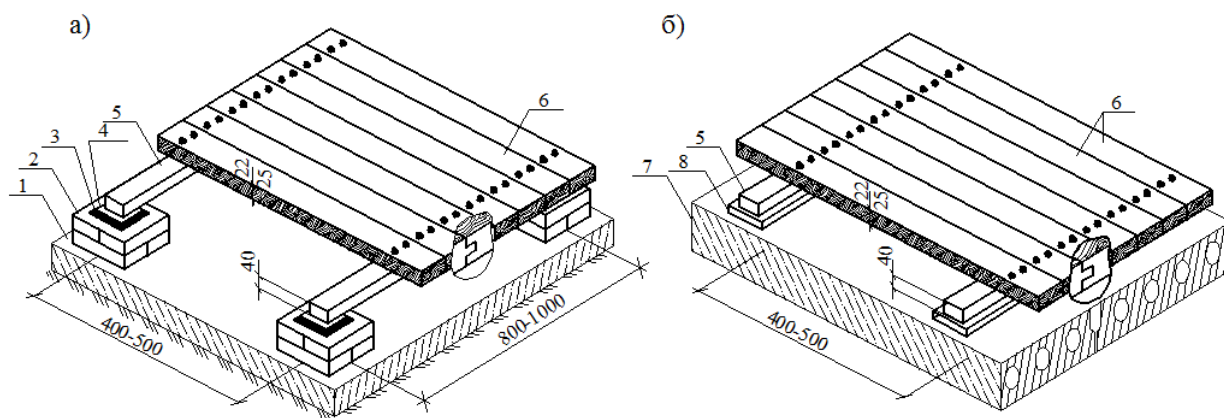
Дощані підлоги по ґрунту (а) і по перекриттю (б): 1 – бетонна підготовка; 2 – цегляний стовпчик; 3 – гідроізоляційна прокладка; 4 – підкладка для вирівнювання; 5 – лага; 6 – шпунтовані дошки; 7 – міжповерхове перекриття; 8 – звукоізоляційна прокладка
